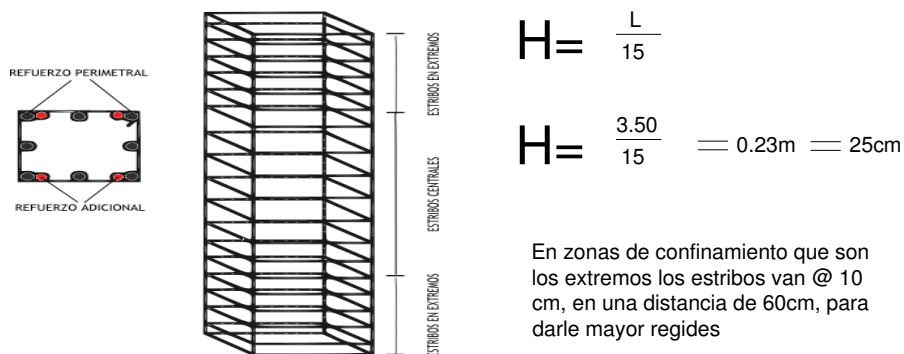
Predimensionamiento de columna estructural elaborado por el autor, ETM
